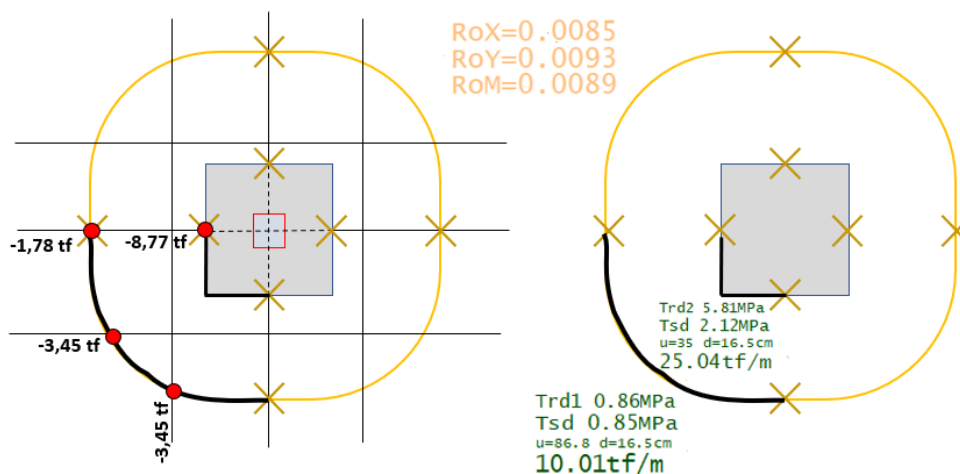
Sub-perímetros da ligação laje-pilar P13
